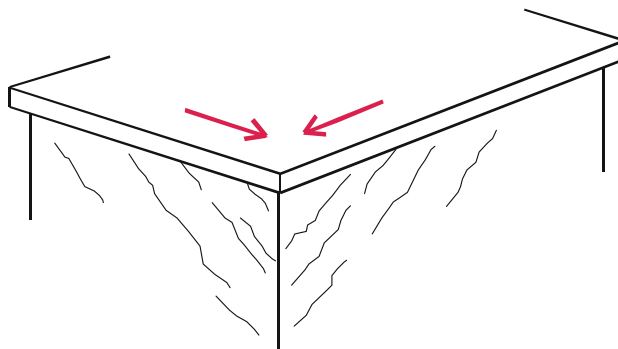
fissuras inclinadas no canto da edificação por movimentação térmica da laje (VERÇOZA, 1991)
